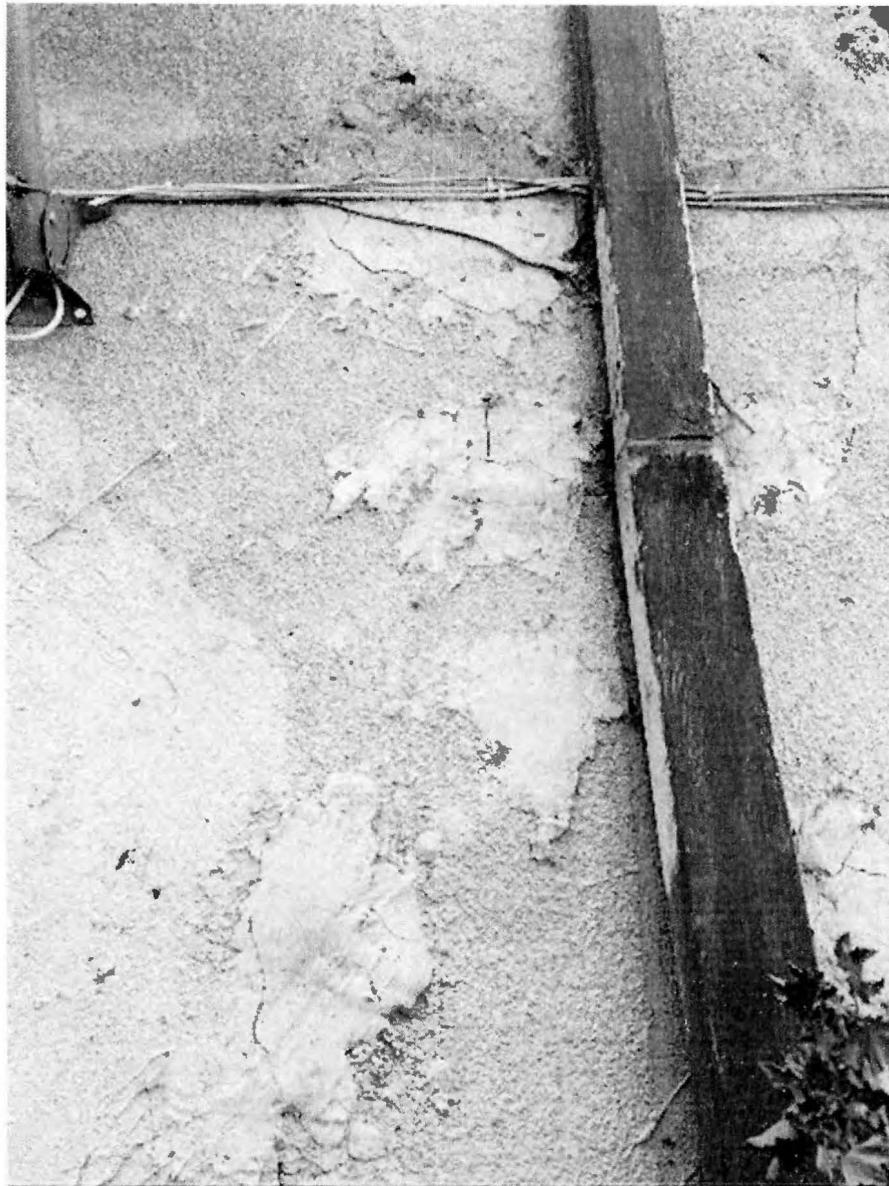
Fisuramiento y soplado de estucos en fachada norte.
